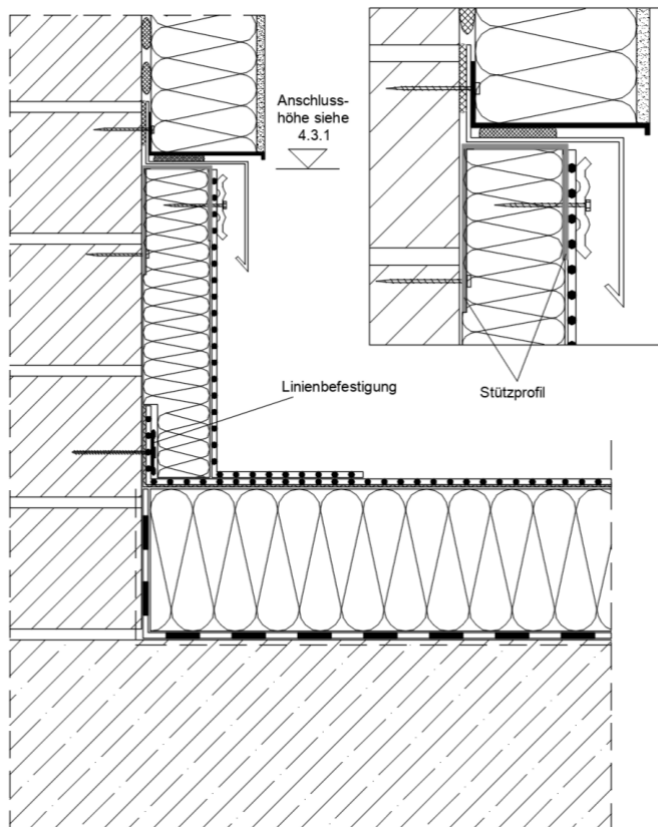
Starrer Wandanschluss mit Kunststoffbahnen und Linienbefestigung – gedämmte Wand mit Wärmedämmverbundsystem
